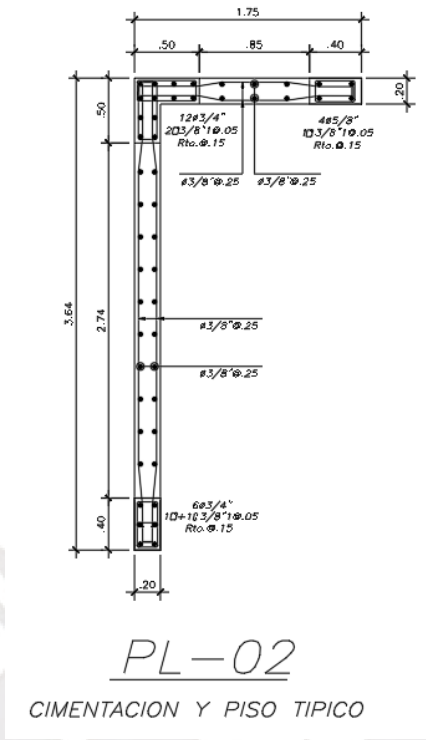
Diseño final de la placa PL-2 para sistema de muros
